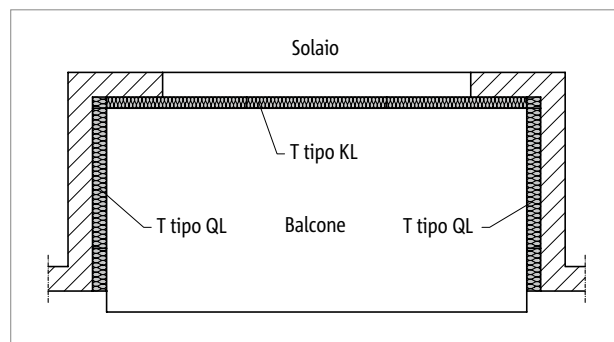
Schöck Isokorb® T tipo KL e tipo QL: balcone con tre appoggi
